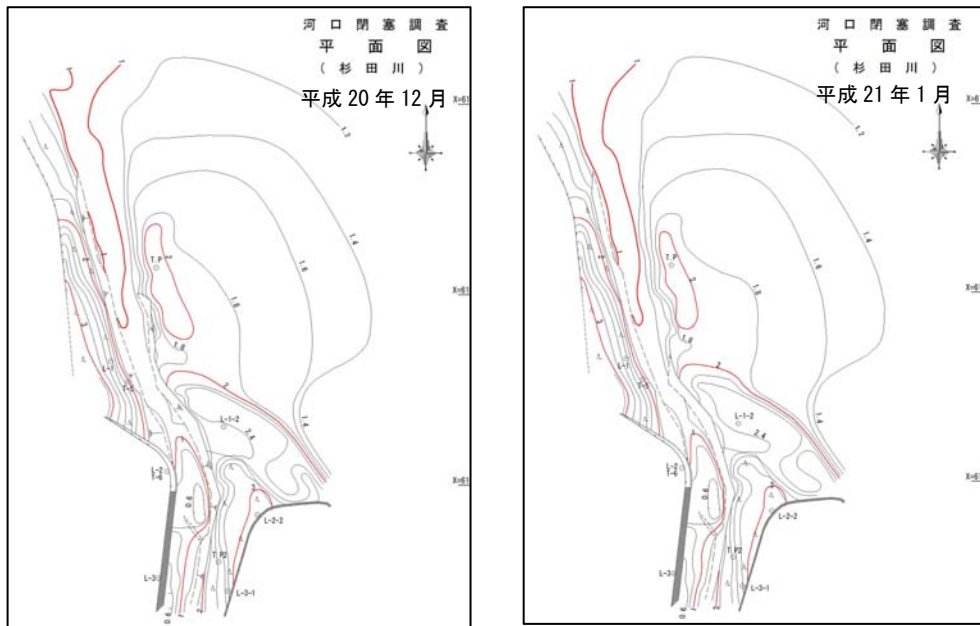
6. 1. 44(3) 杉田川河口部の平面図
